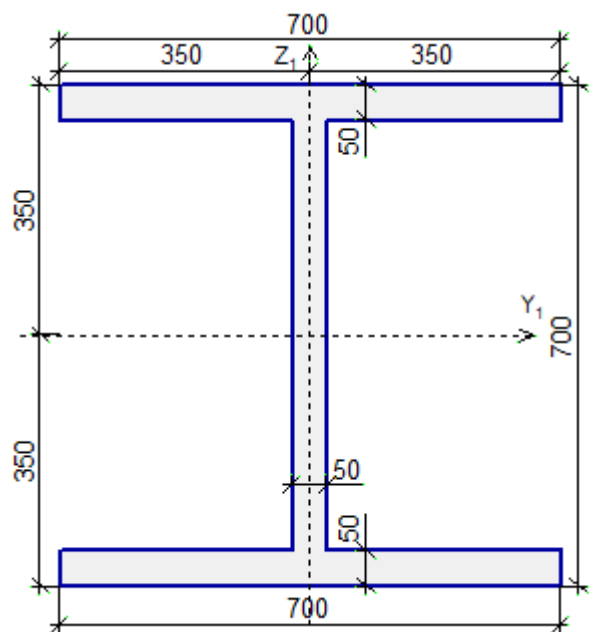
Сечение нижнего пояса фермы рамы
